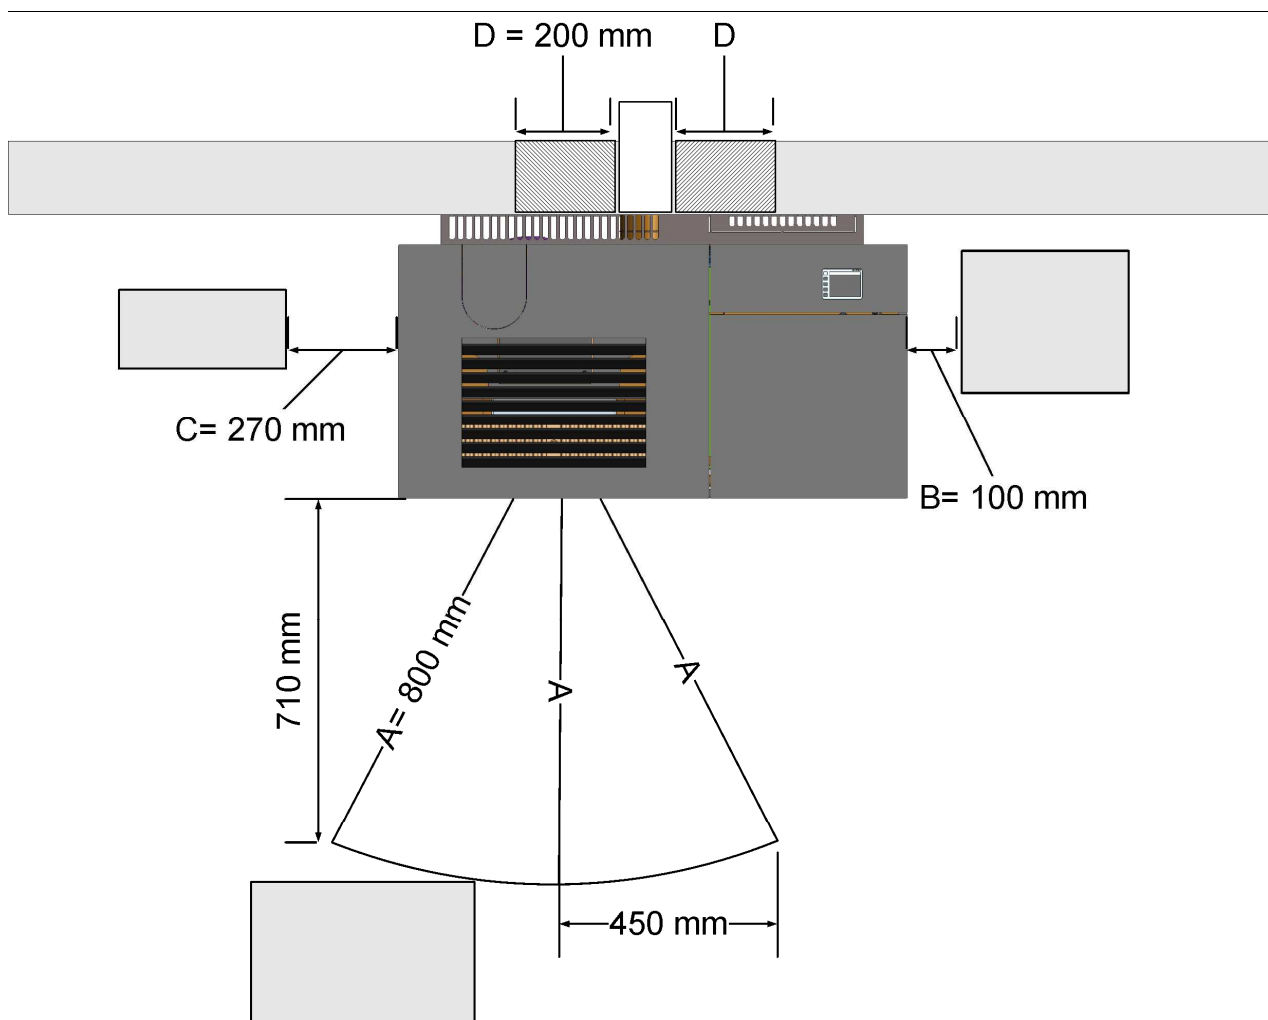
Brandschutzabstände horizontaler Anschluss ixbase
